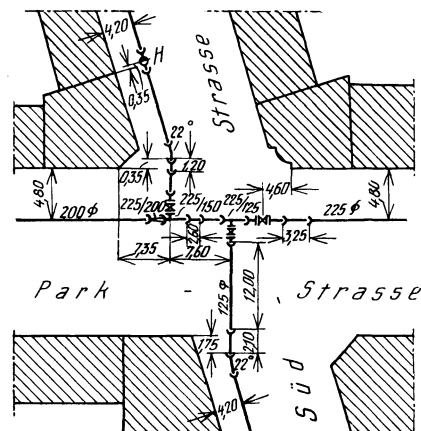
Rohrnetzplan. (Nach P. Brinkhaus)
